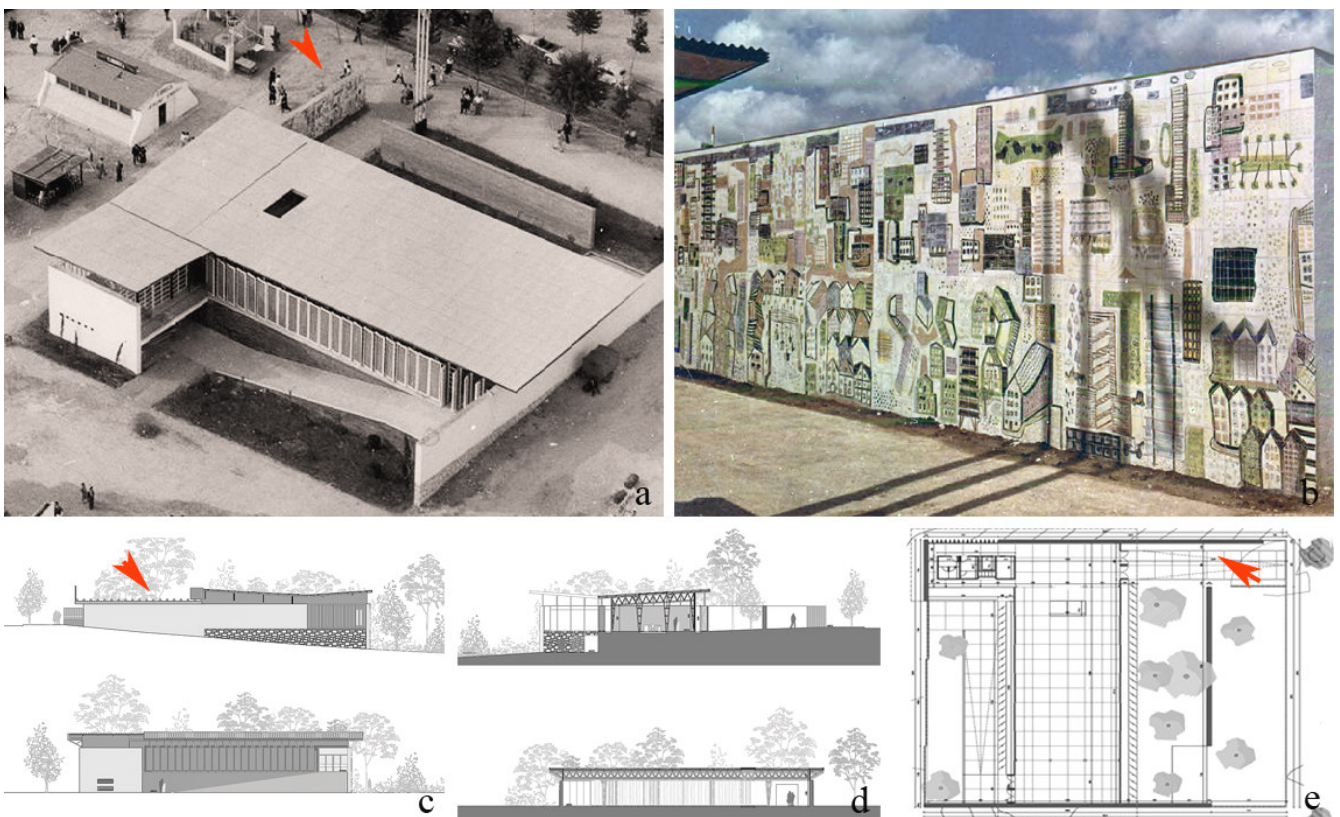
a) Localización del mural en una vista aérea del pabellón en el año 1956 (Archivo Cabrero); b) vista general del panel cerámico en el año 1956; c, d, e) alzados y planta del pabellón (2018) con indicación de la situación del panel cerámico. Fuente: Coca y Barbero (2019).
